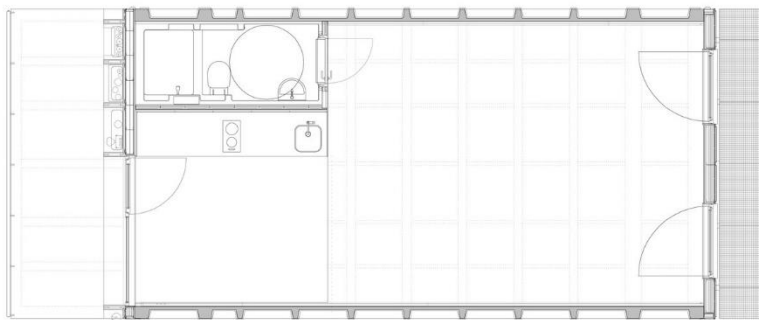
Planta del diseño de las habitaciones moduladas, FUENTE: Arch Daily
